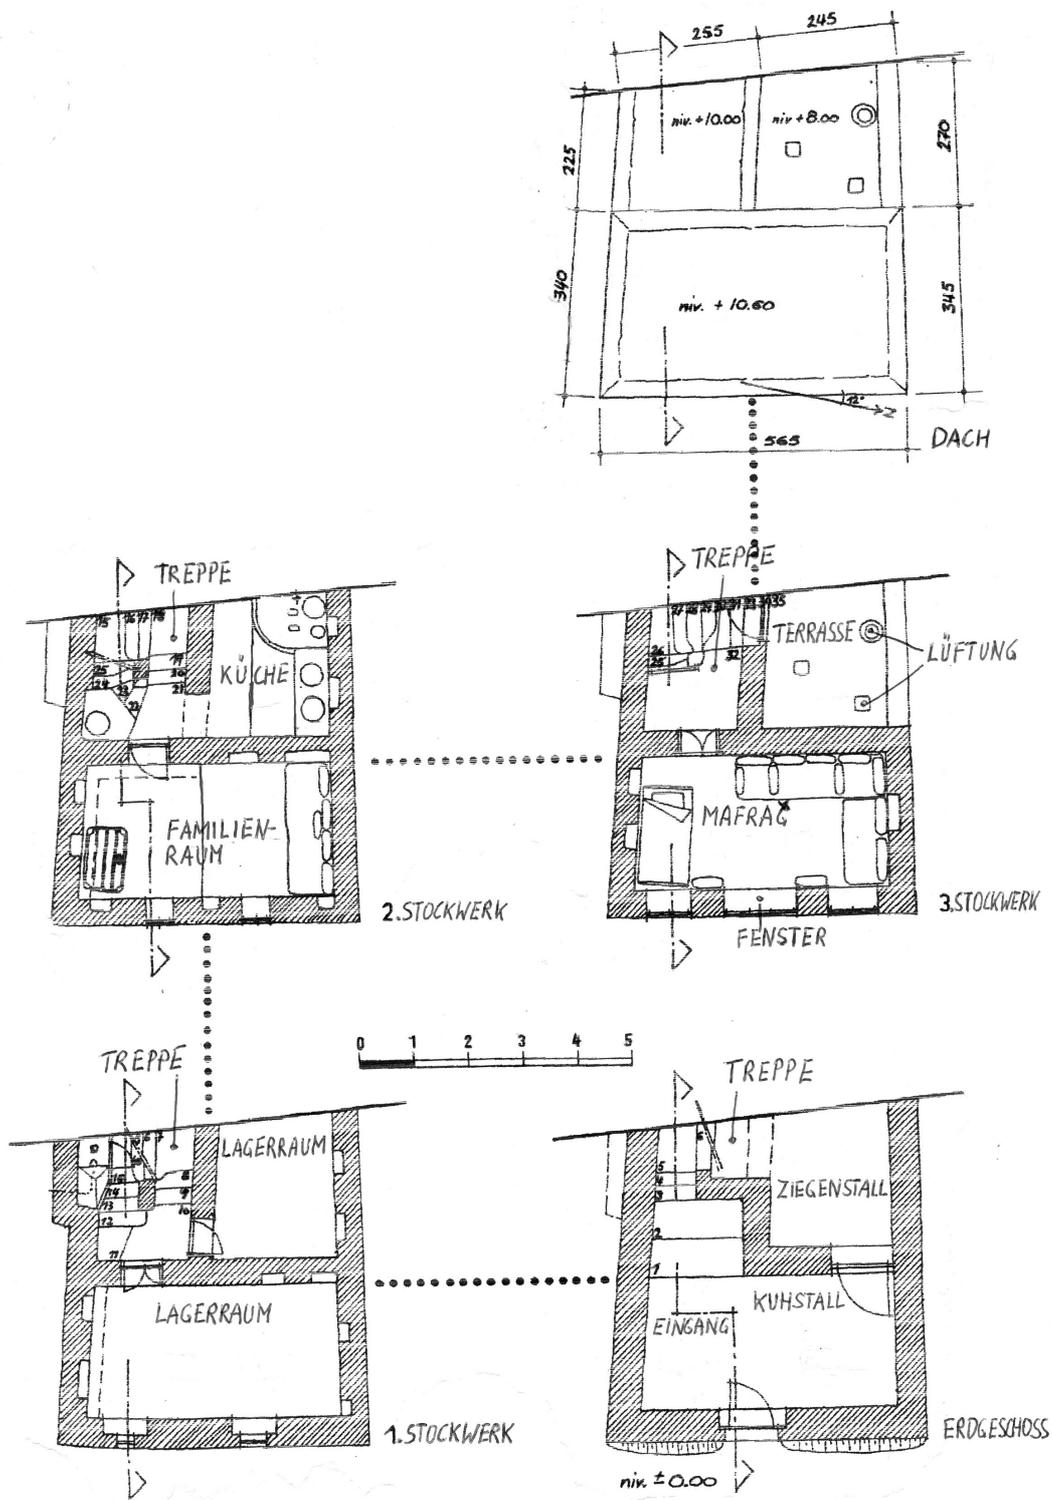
Grundrisse der Etagen im Haus eines Kleinbauern
